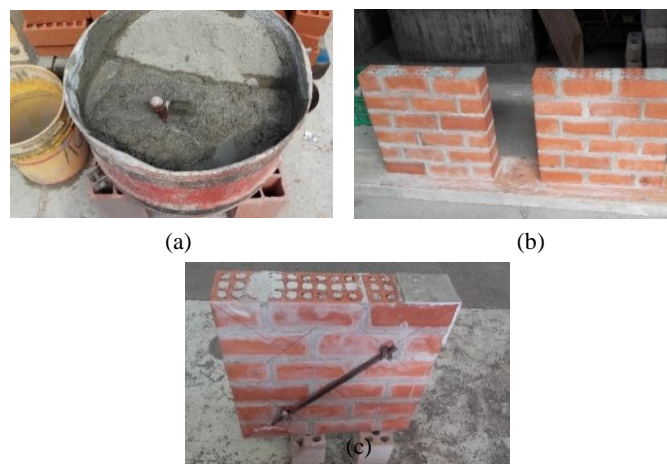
(a) Mezcla de mortero preparada, (b) hileras de ladrillos asentadas, (c) murete terminado e instrumentado
